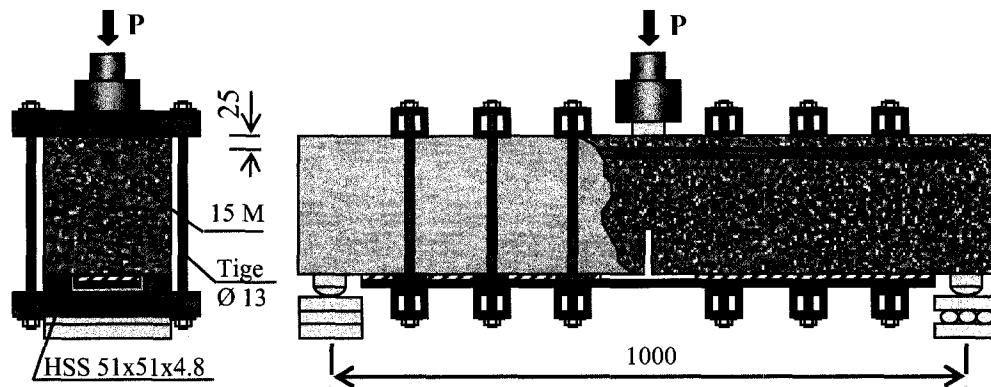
Poutrelles du Groupe C : renforcement en cisaillement @125 mm
